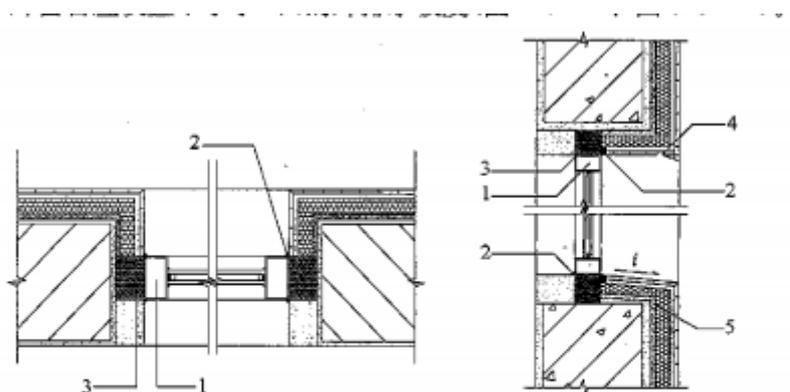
门窗框防水水平剖面构造 图 5.3.1-2 门窗框防水立剖面构造
